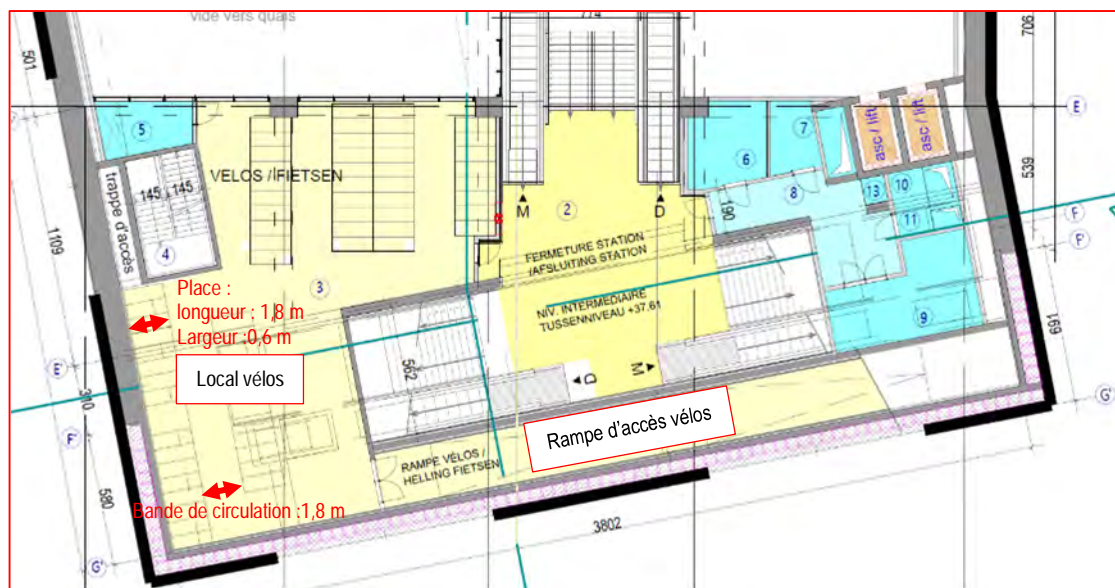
Vue en plan et coupe du local vélos en sous-sol et de la rampe d'accès (BMN, 2018)
